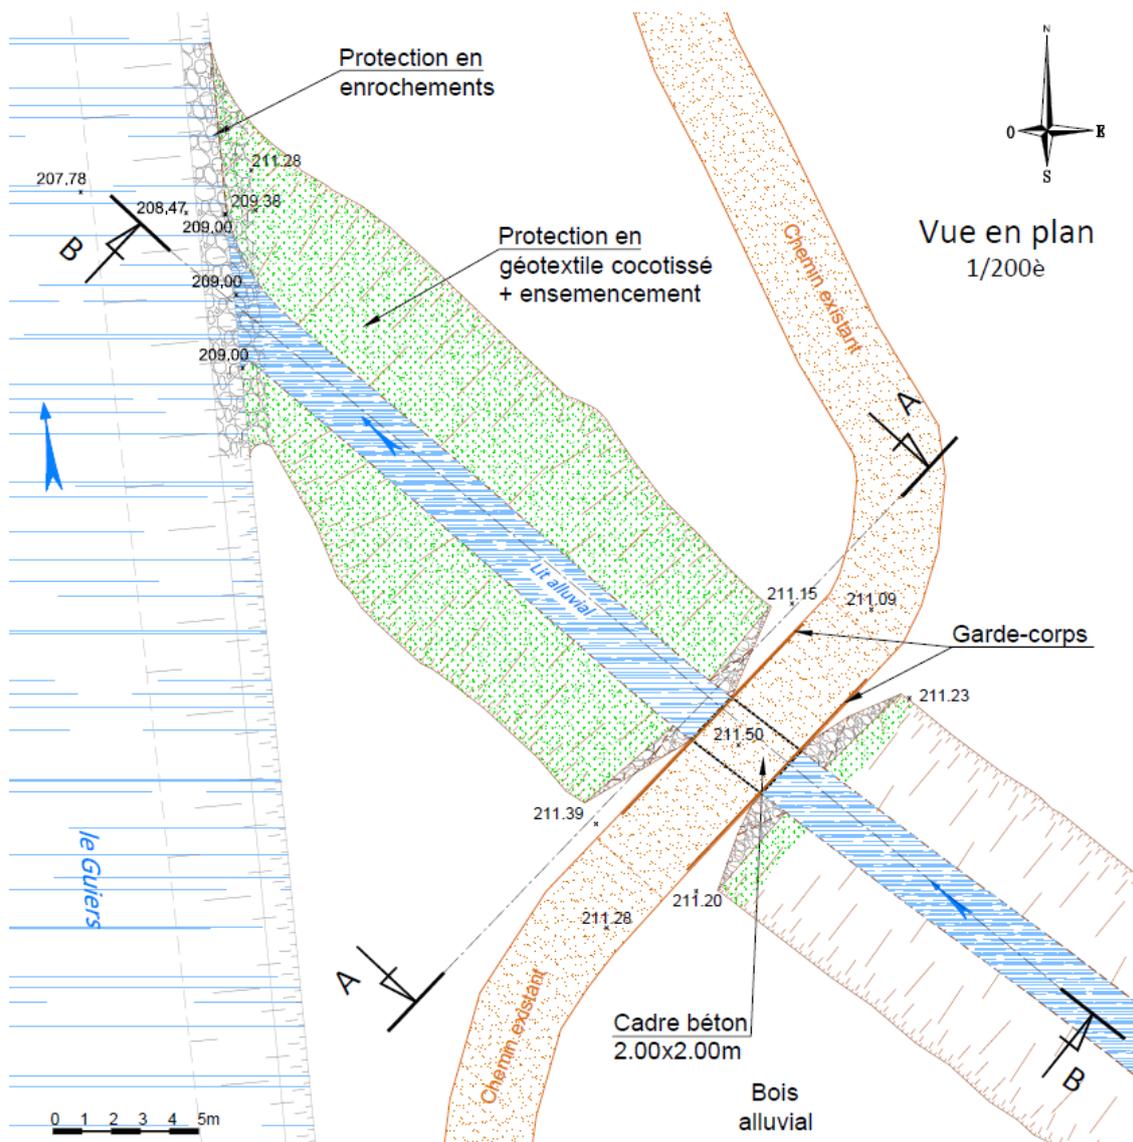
Vue en plan de l'ouvrage d'alimentation du bras secondaire
